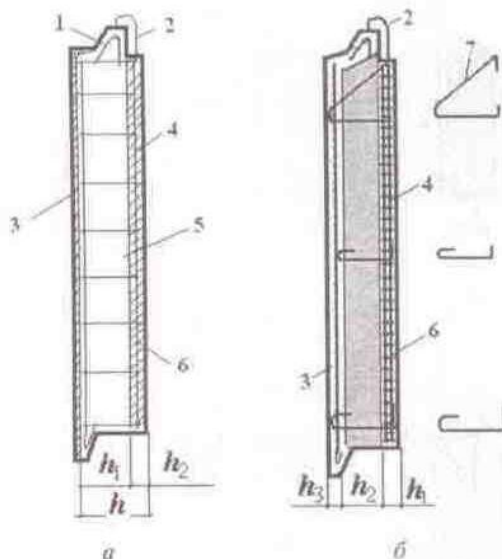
Збірні шаруваті панелі: а – двошарова панель; б – тришарова панель з гнучкими в'язями; 1 – арматурна сітка; 2 – петля для підйому; 3 – облицювальний шар; 4 – шар важкого бетону; 5 – шар легкого бетону; 6 – вертикальний каркас; 7 – гнучкі в'язі
